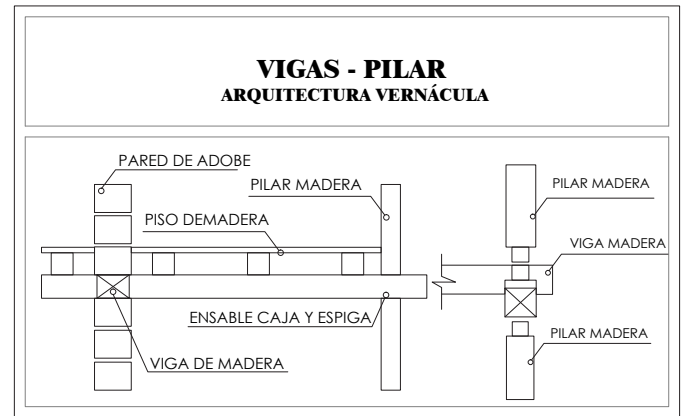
Armado de viga y pilares en la arquitectura vernácula.
